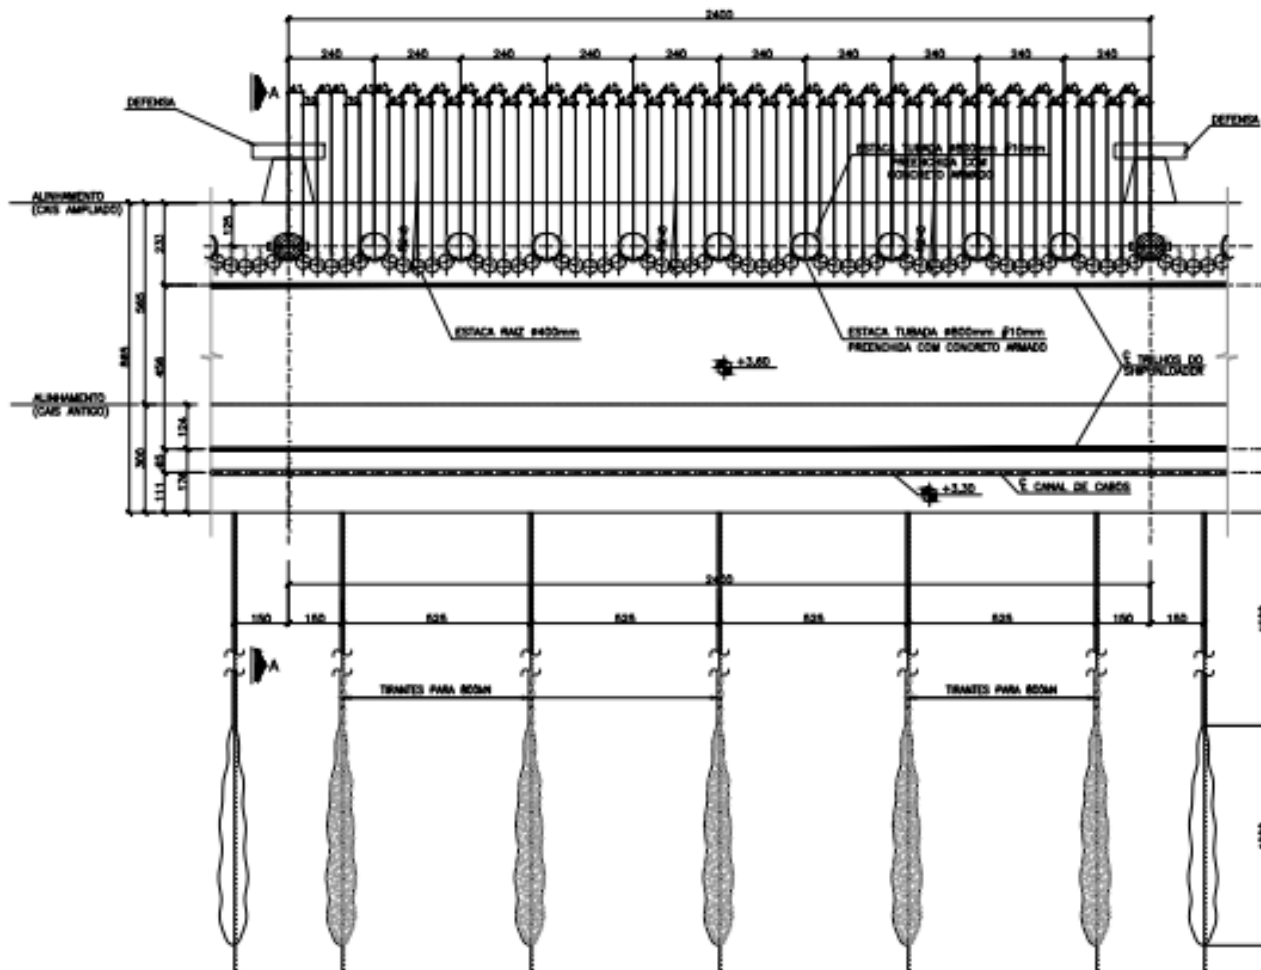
Planta típica da estrutura por módulo de 24,00m.
